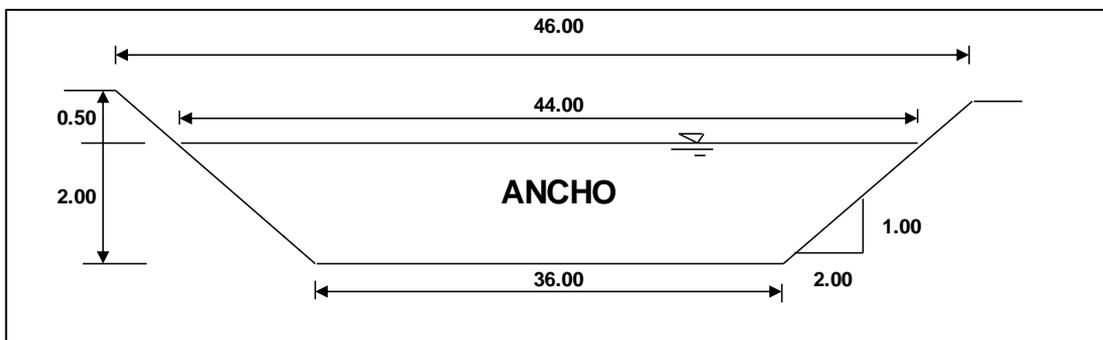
Sección transversal a lo ancho de la laguna de oxidación secundaria proyectada.
